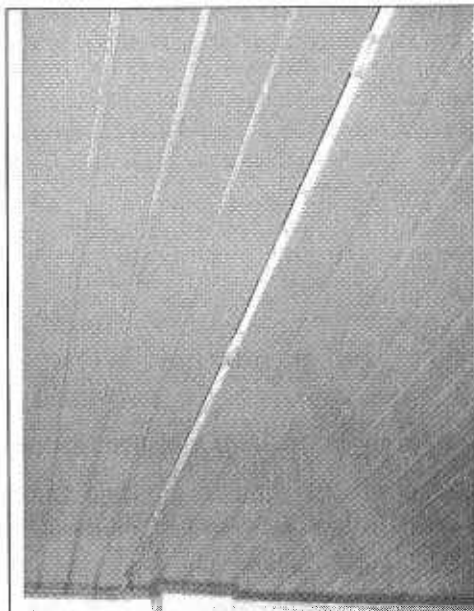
Dilatación en láminas de madera del cielorraso del primer nivel de la vivienda, en el punto de contacto entre las dos etapas de construcción.
